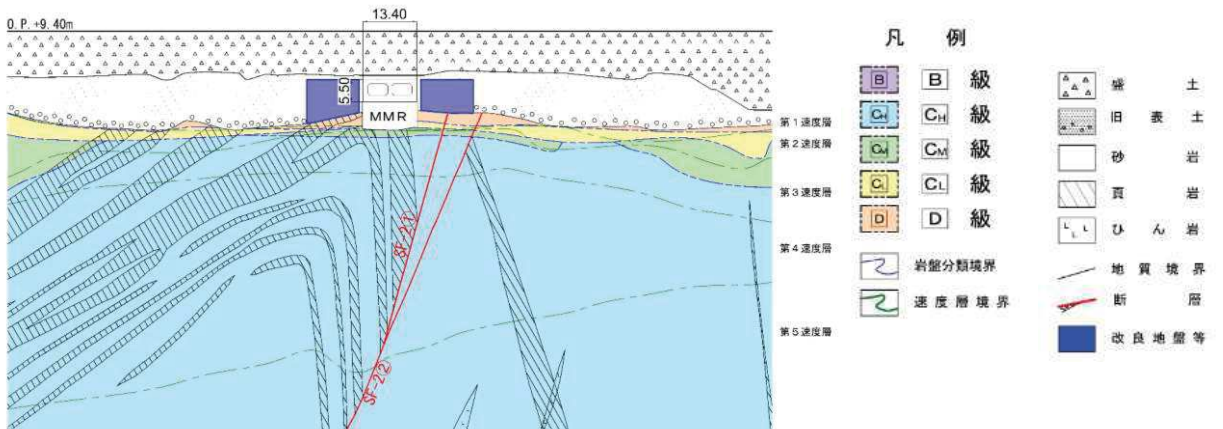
地盤改良体の配置図（取水路，B-B 断面）
